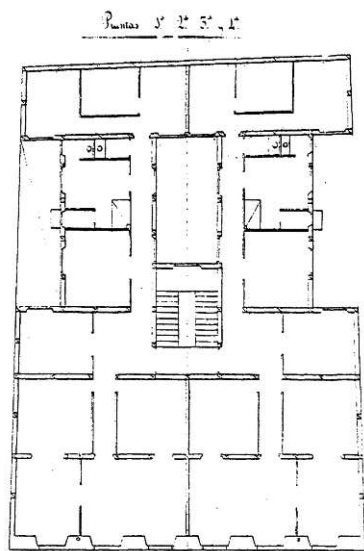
Grundriss der Obergeschosse, Calle de Claudio Coello 42
